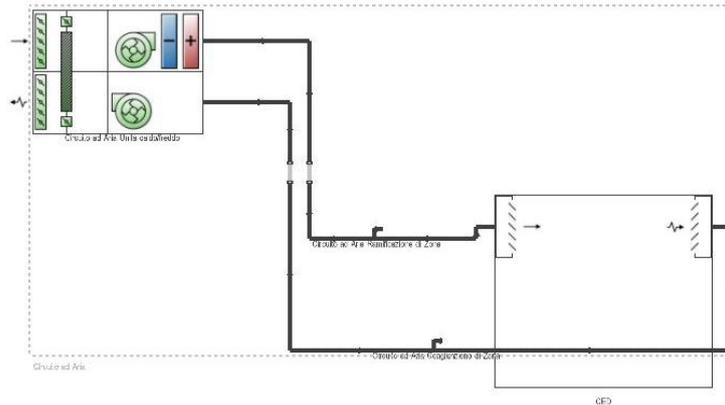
Impianto HVAC del CED del Proposed Building realizzato su DB
